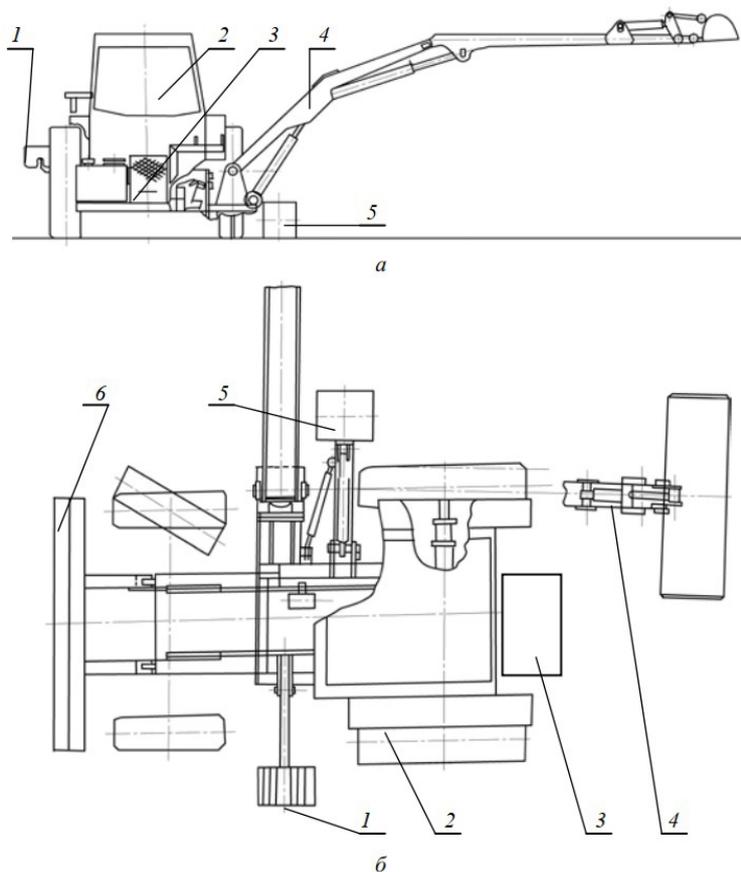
Каналоочиститель многоцелевой ОКН: а — вид сзади; б — вид сверху; 1 — противовес; 2 — трактор; 3 — насосная станция; 4 — стрела; 5 — опорное колесо; 6 — бульдозерный отвал
